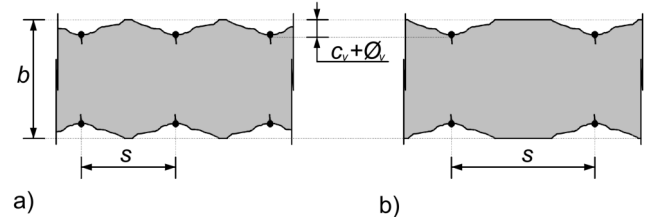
Vista esquemática del desconchado del hormigón en el alma de una viga debido a la corrosión. Adaptado de [10].
